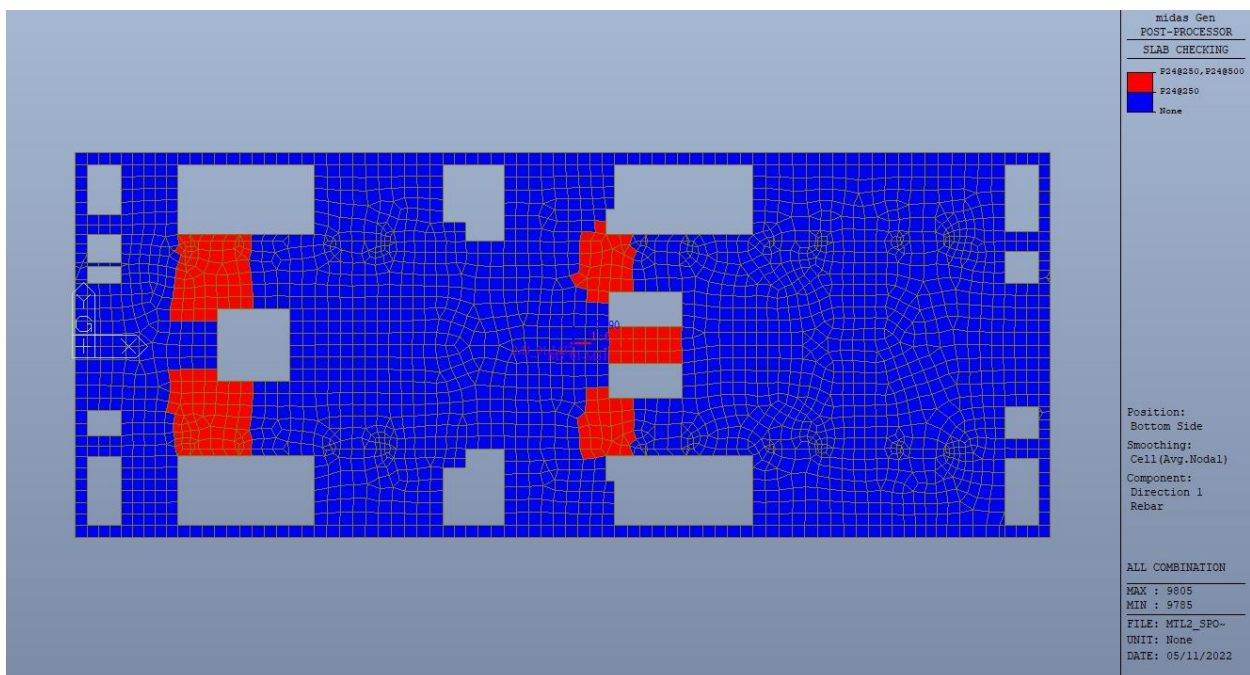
Piano mezzanino (-3) – Armatura inferiore direzione D1
